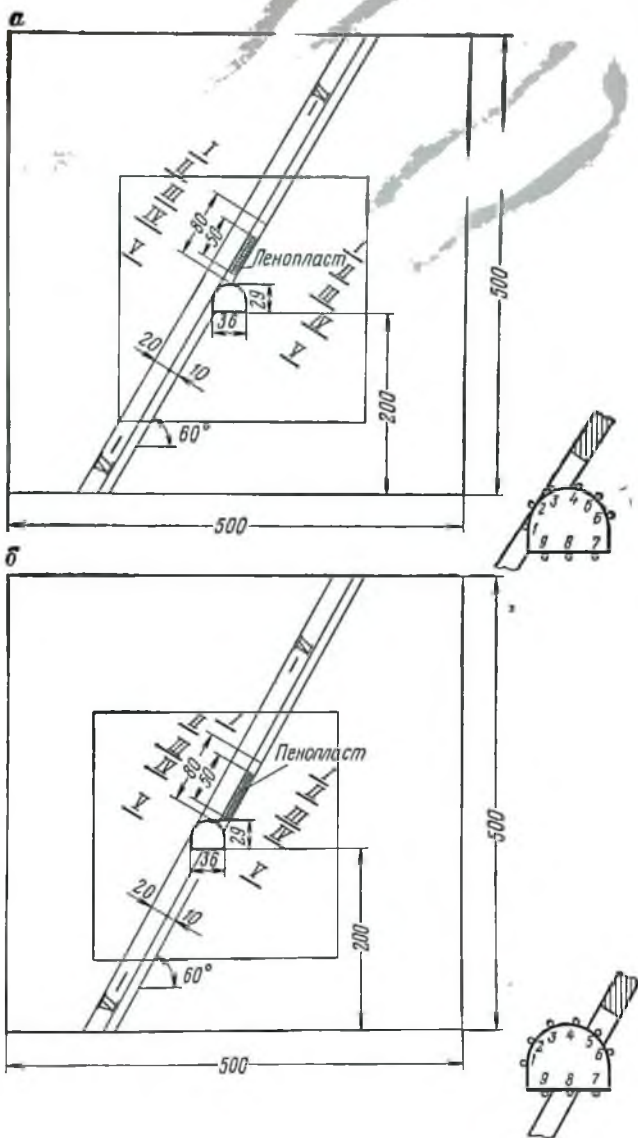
Схема расположения выработки в модели: а — без подрывки пород кровли; б — при подрывке пород кровли
